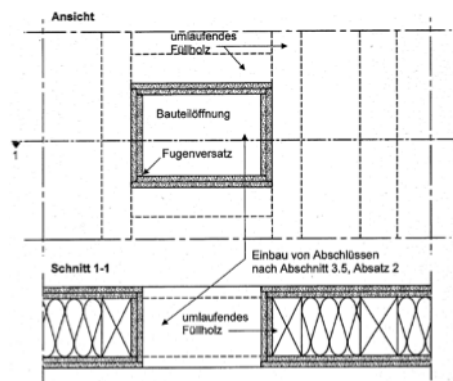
Bauteilöffnung mit Brandschutzbekleidung zum Einbau von Türen, Fenstern und sonstigen Einbauten nach der M-HFH-HolzR. Darstellung der Ausführung des Fugenversatzes
